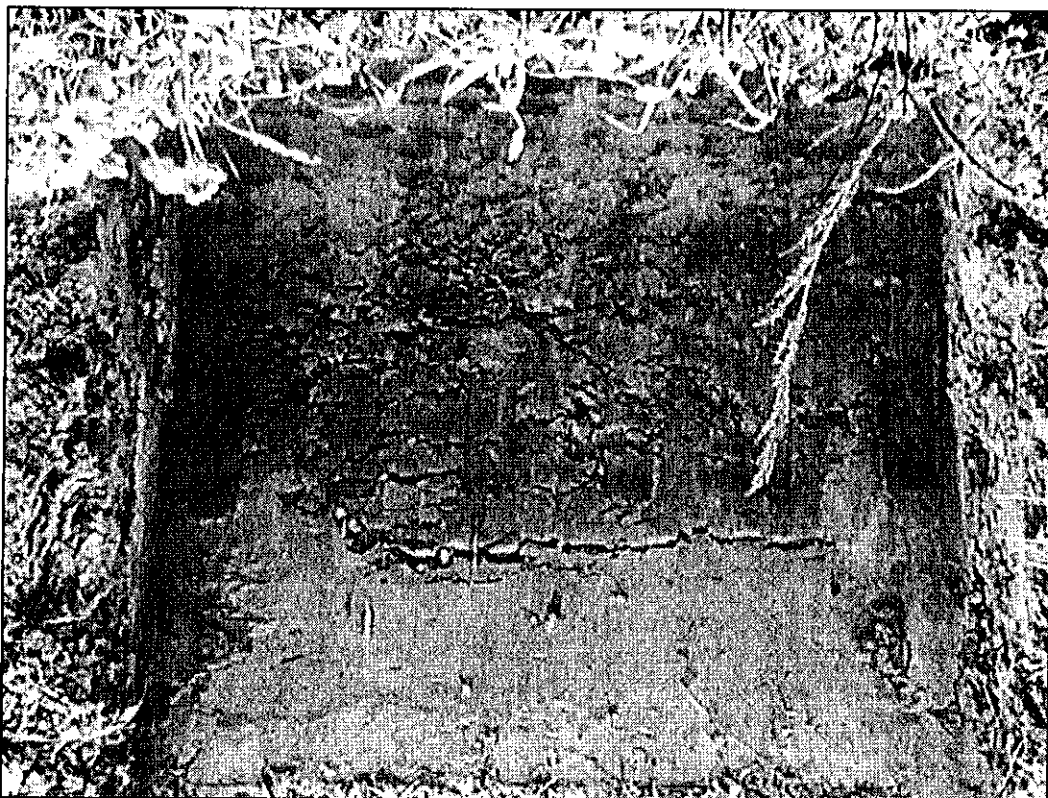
Pozzetto n° 19. Profondità -1.5 m dal p.c.
